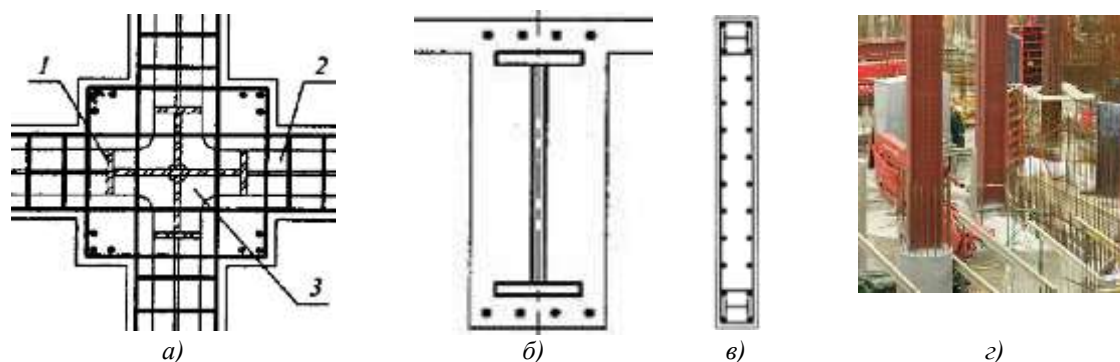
Принципиальные схемы поперечных сечений и общего вида сталежелезобетонных конструкций несущего остова высотных зданий.
